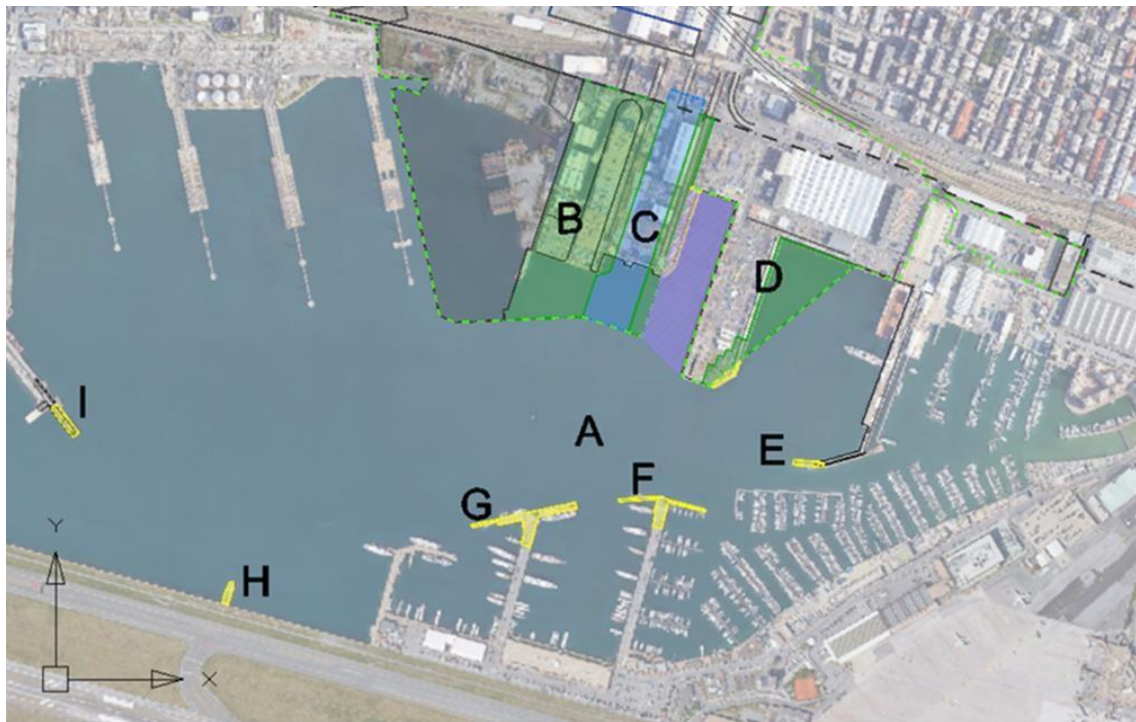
Layout di progetto del bacino di Sestri Ponente.
